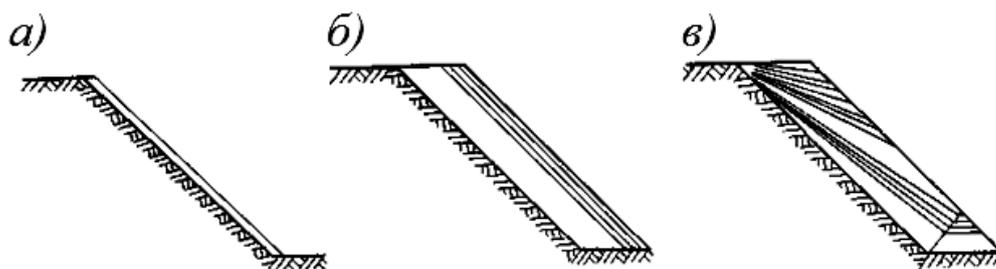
Схемы выемки горной массы цепными экскаваторами:
